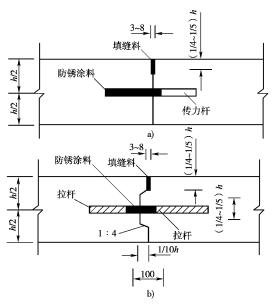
横向施工缝构造(尺寸单位 mm) a)设传力杆平缝型 为)设拉杆企口缝型 传力杆尺寸和间距(mm)
